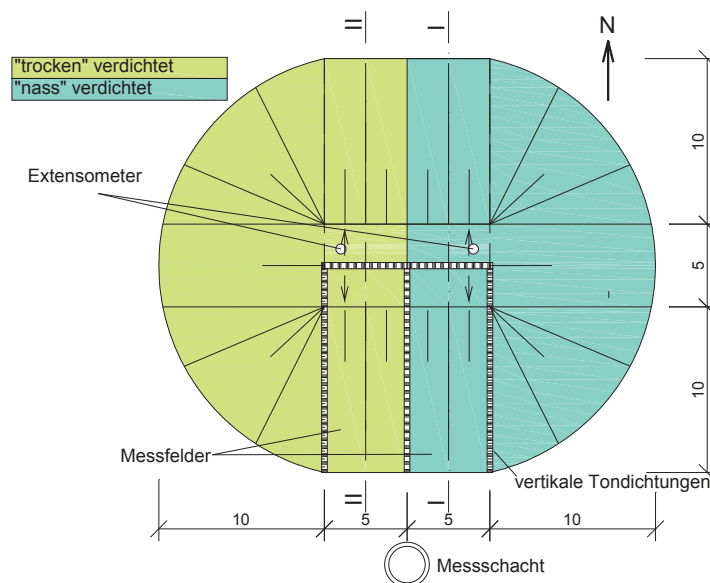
Grundriss der Versuchsschüttung (Prinzipdarstellung)
